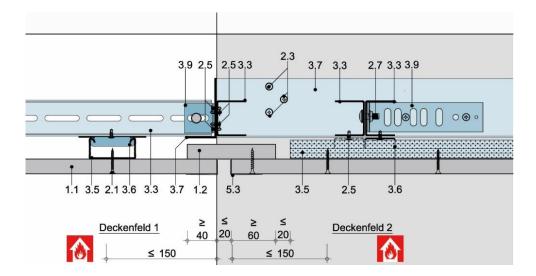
Flurkreuzung einer einlagig beplankten Weitspannträgerdecke mit Schattenfuge
